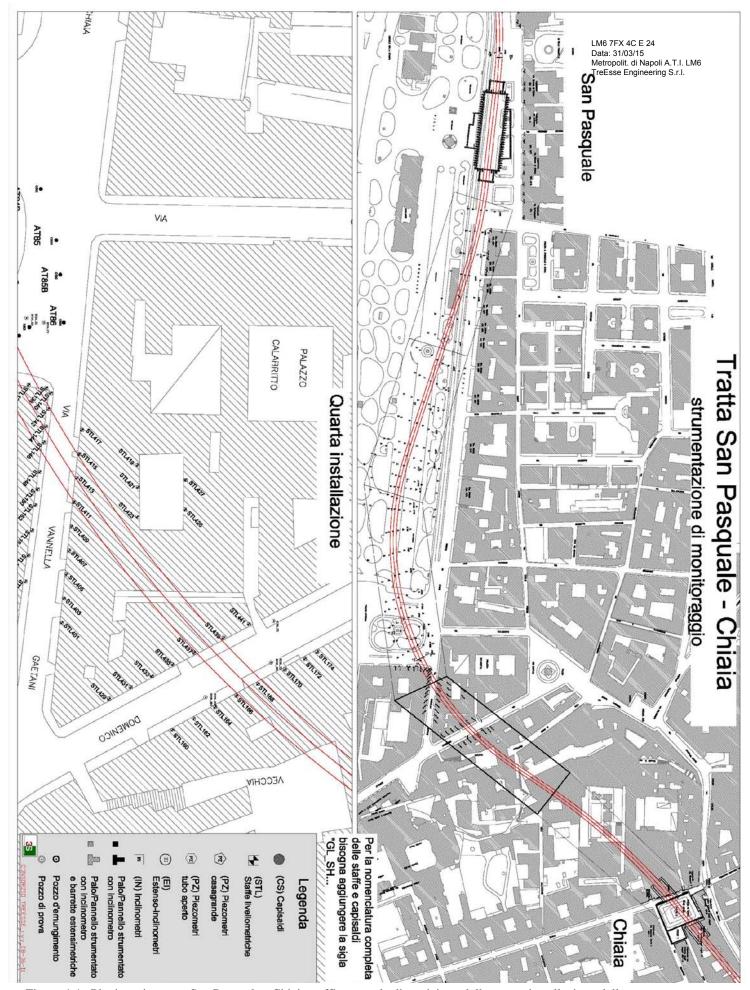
Planimetria tratta San Pasquale - Chiaia, raffigurante la disposizione della quarta installazione della strumentazione di monitoraggio.
